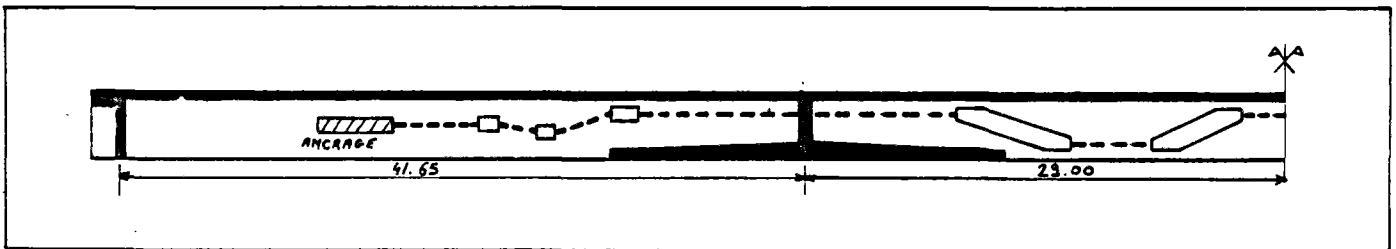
Profil en long des câbles sur l'âme (J.N. Theillout, 1981 a)
